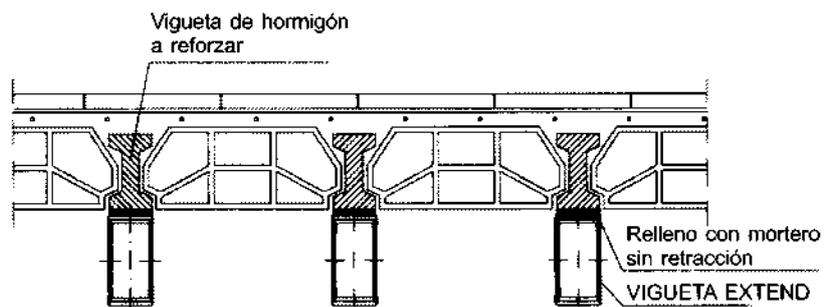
Sección refuerzo. Vigueta de hormigón con bovedilla.
